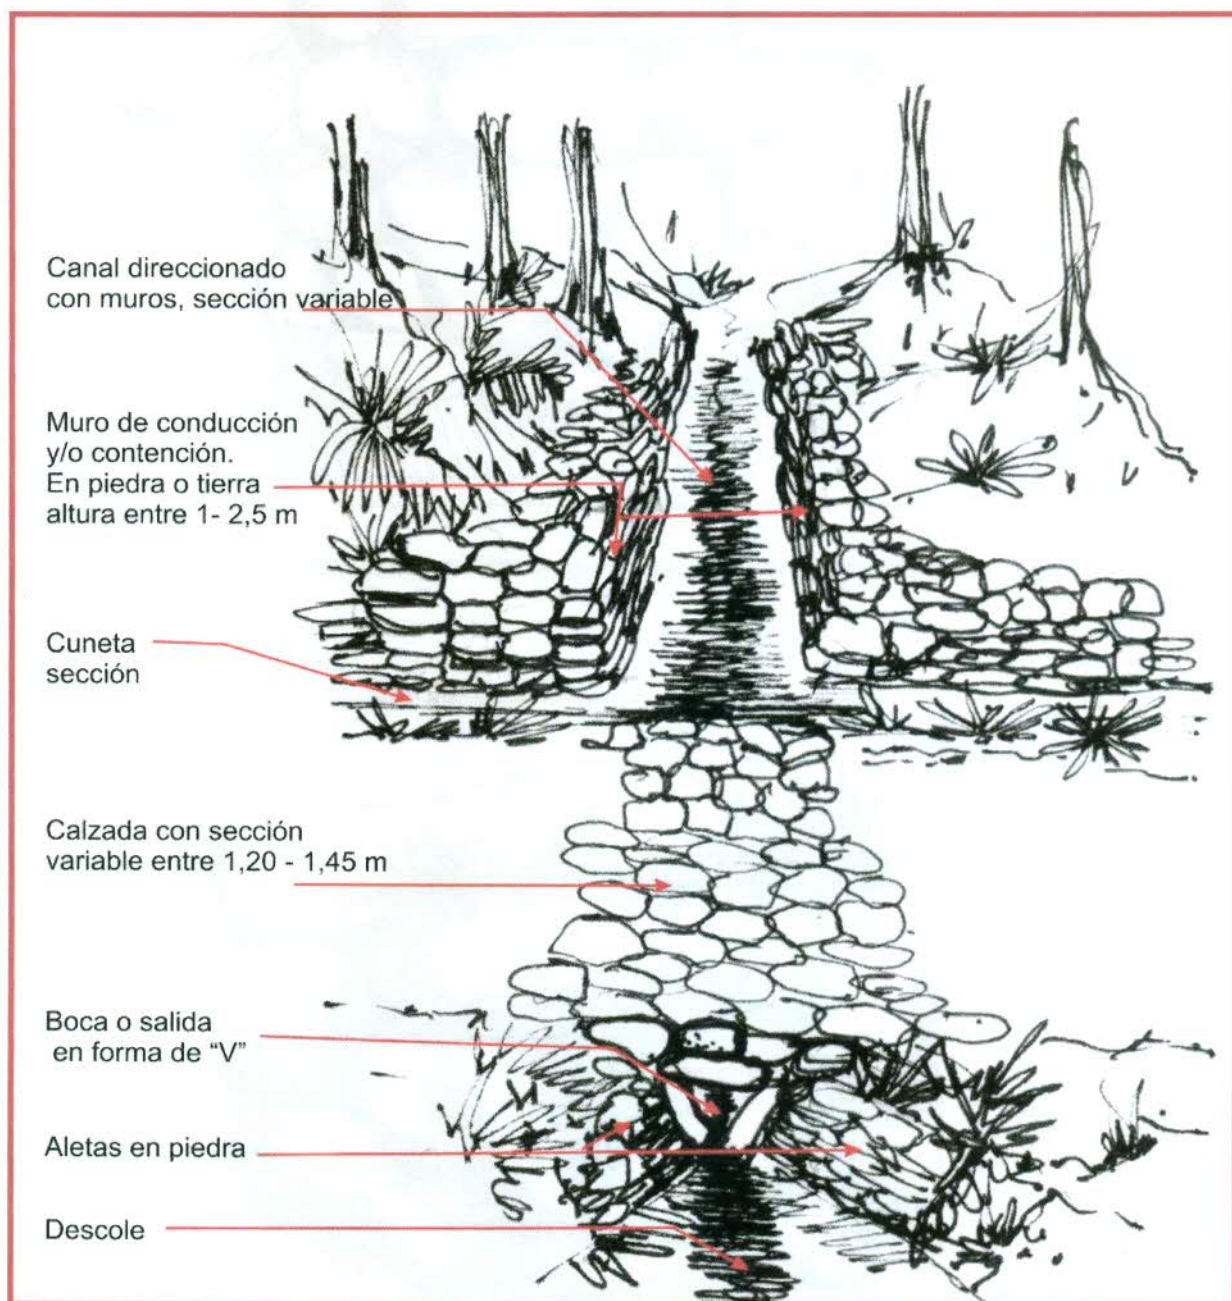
Obra hidráulica subterránea transversal en forma de "v"
